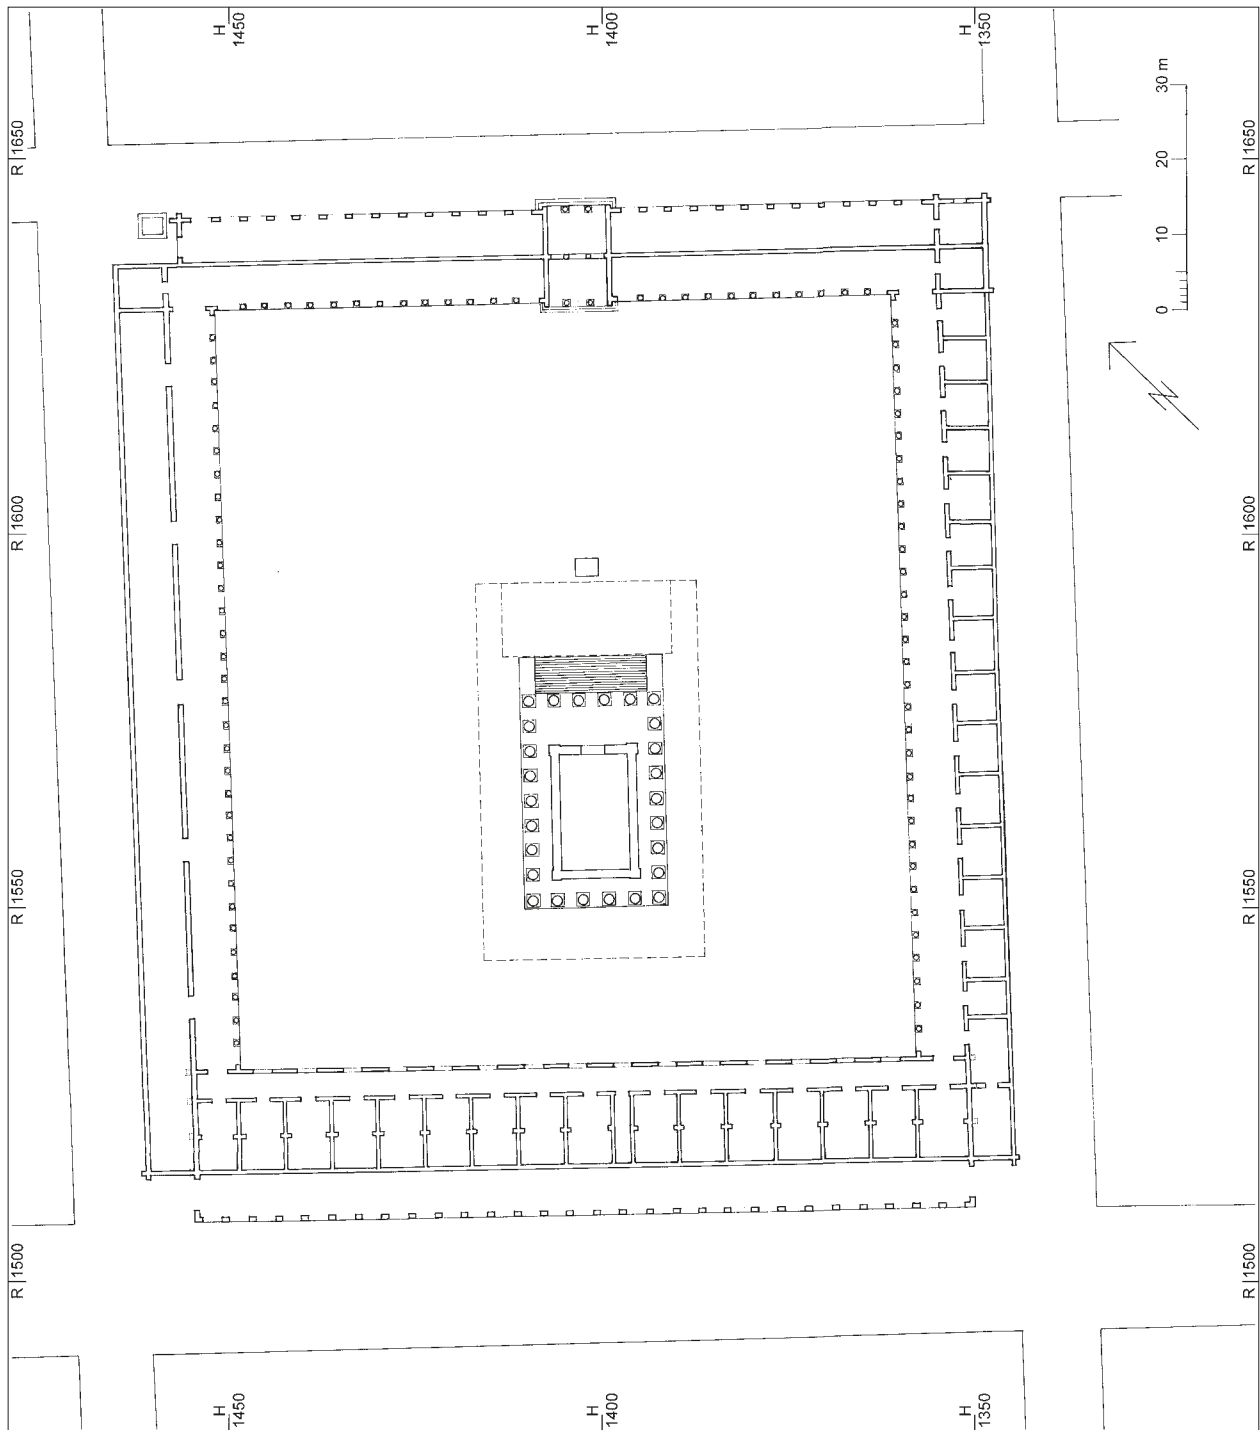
Periode 8a, Capitoltempel mit Randbebauung, Grundriss, Rekonstruktion, zweiter Tempelbau gestrichelt. – M. 1:1000.
